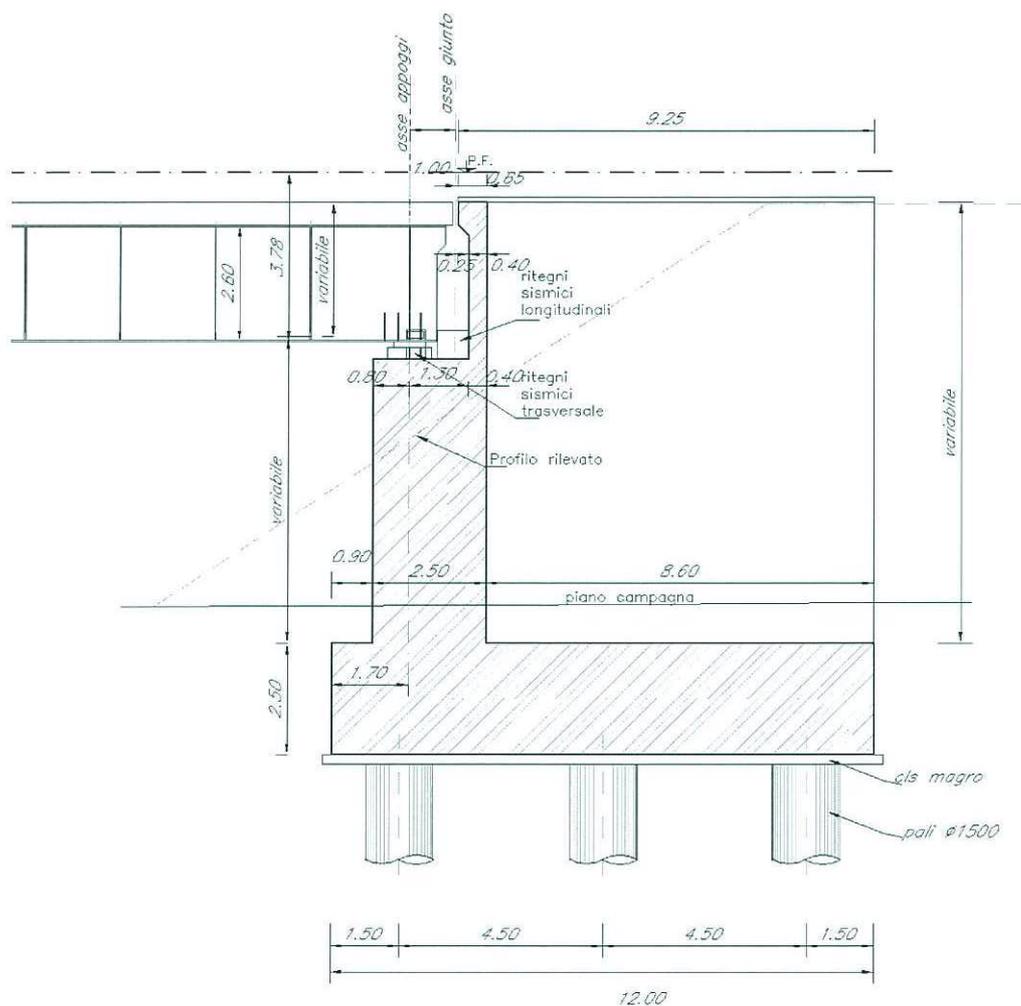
Sezione longitudinale della spalla tipo.
